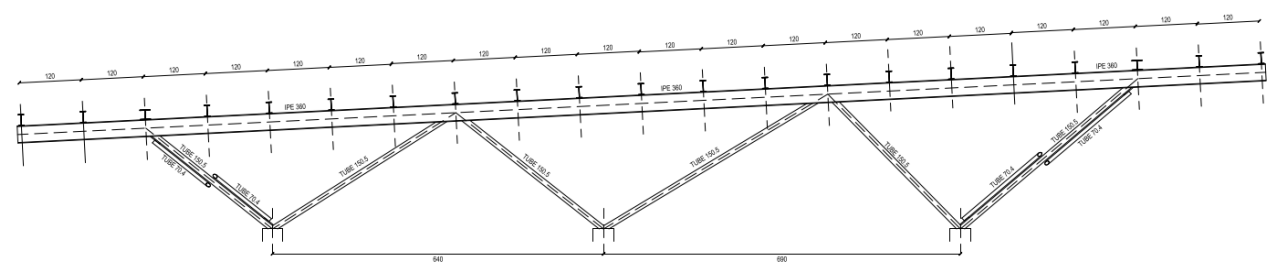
Sección tipo estructura de cubierta (Food and Drug Quality Control Laboratory)
